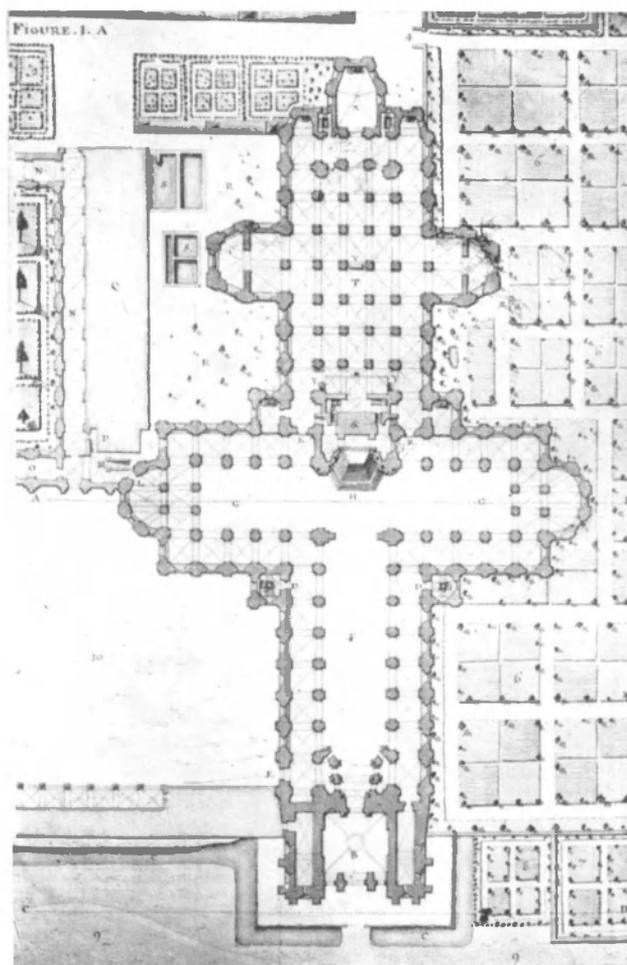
Saint-Amand. — Eglise abbatiale : plan du rez-de-chaussée par Cl. Masse, 1725.
